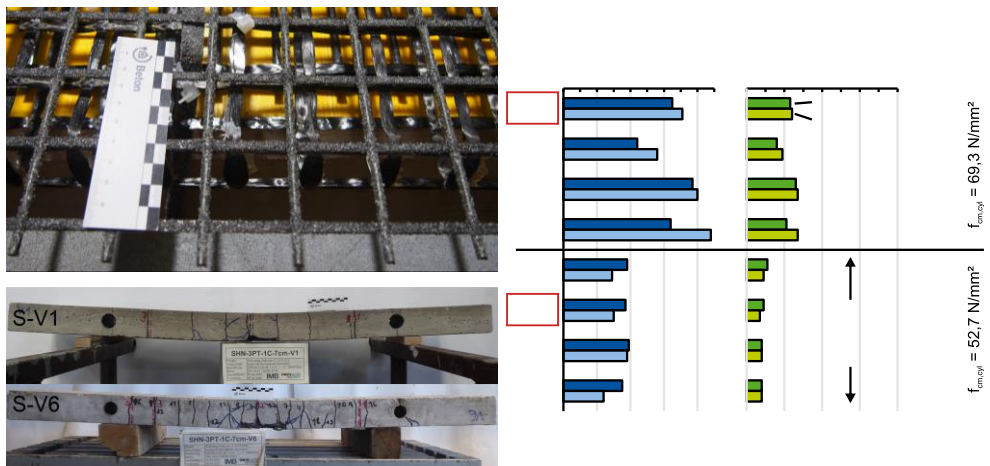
Besandete Bewehrung in oberer Lage beim Rheinsteg Albrück (links oben), Vergleich Rissanzahl unbesandete (S-V1)/besandete Bewehrung (S-V6) (links unten); Vergleich der mittleren Trennrissbreiten bei besandeter und unbesandeter Bewehrung (Quelle: IMB RWTH, Bild rechts nach [3])
